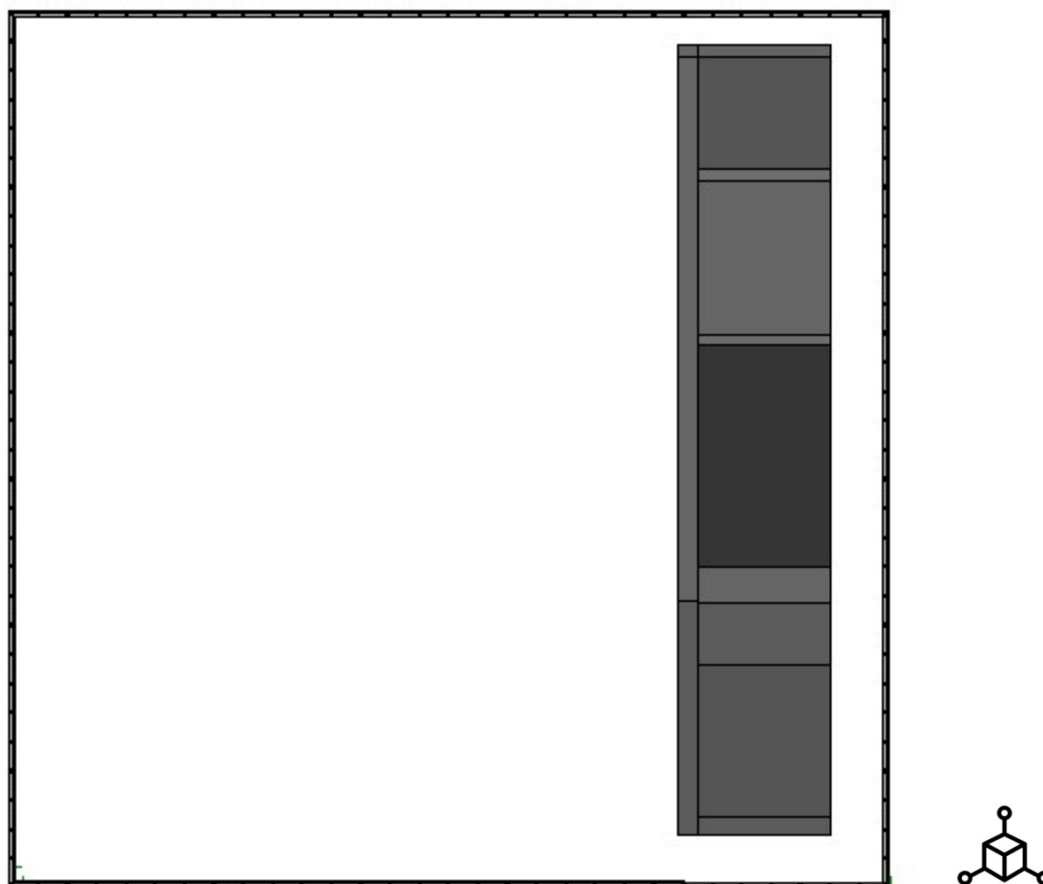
Pianta pavimento piano trentesimo (fuori scala).
